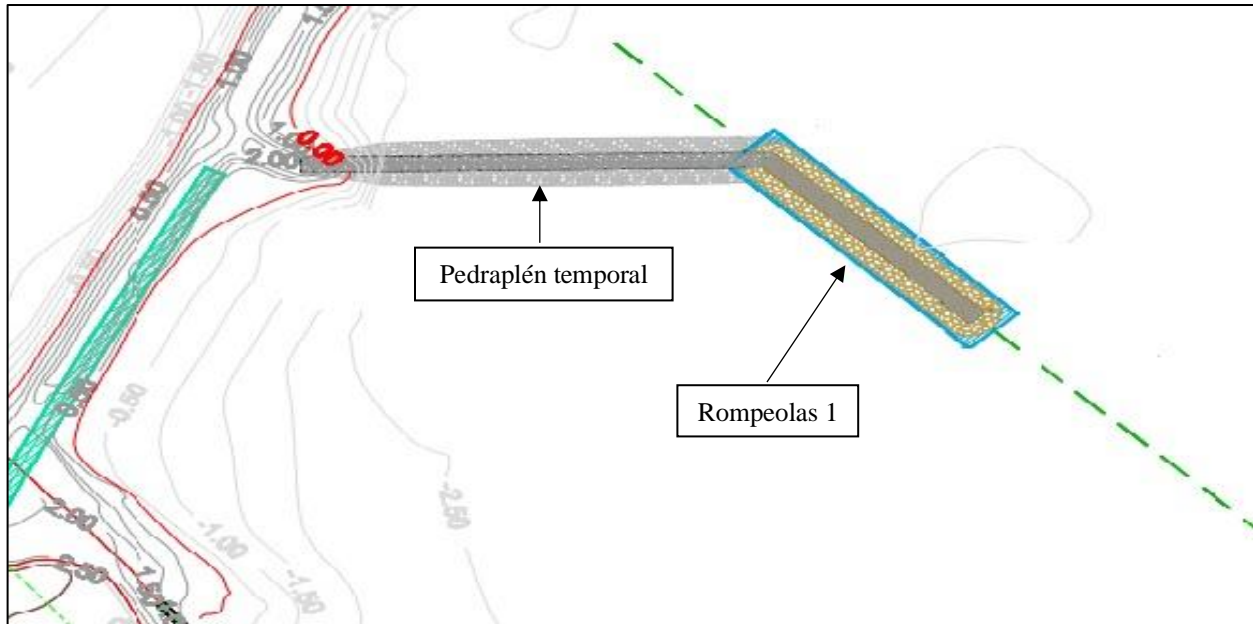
Ubicación del pedraplén temporal para construir el rompeolas 1, en la zona M1.
